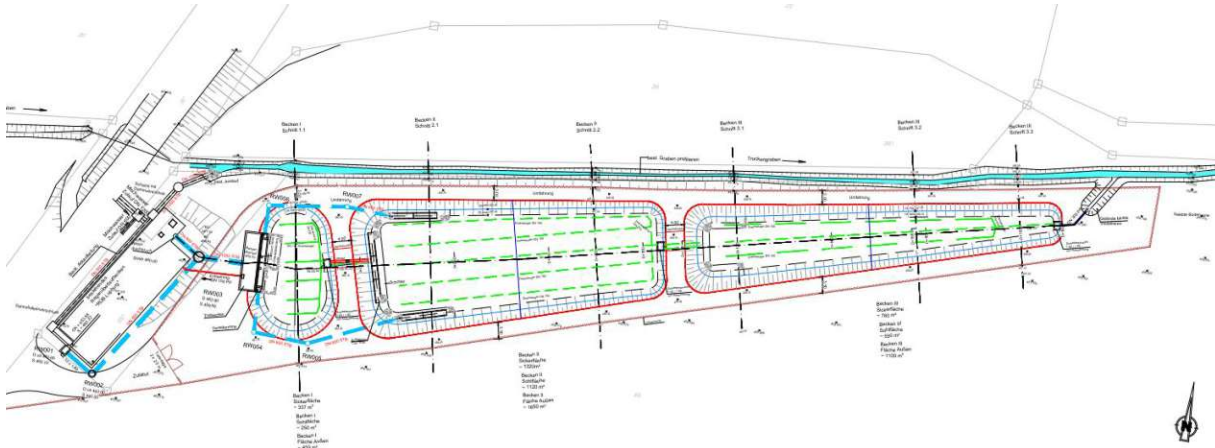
Grundriss der geplanten Sandfilteranlage [27]
